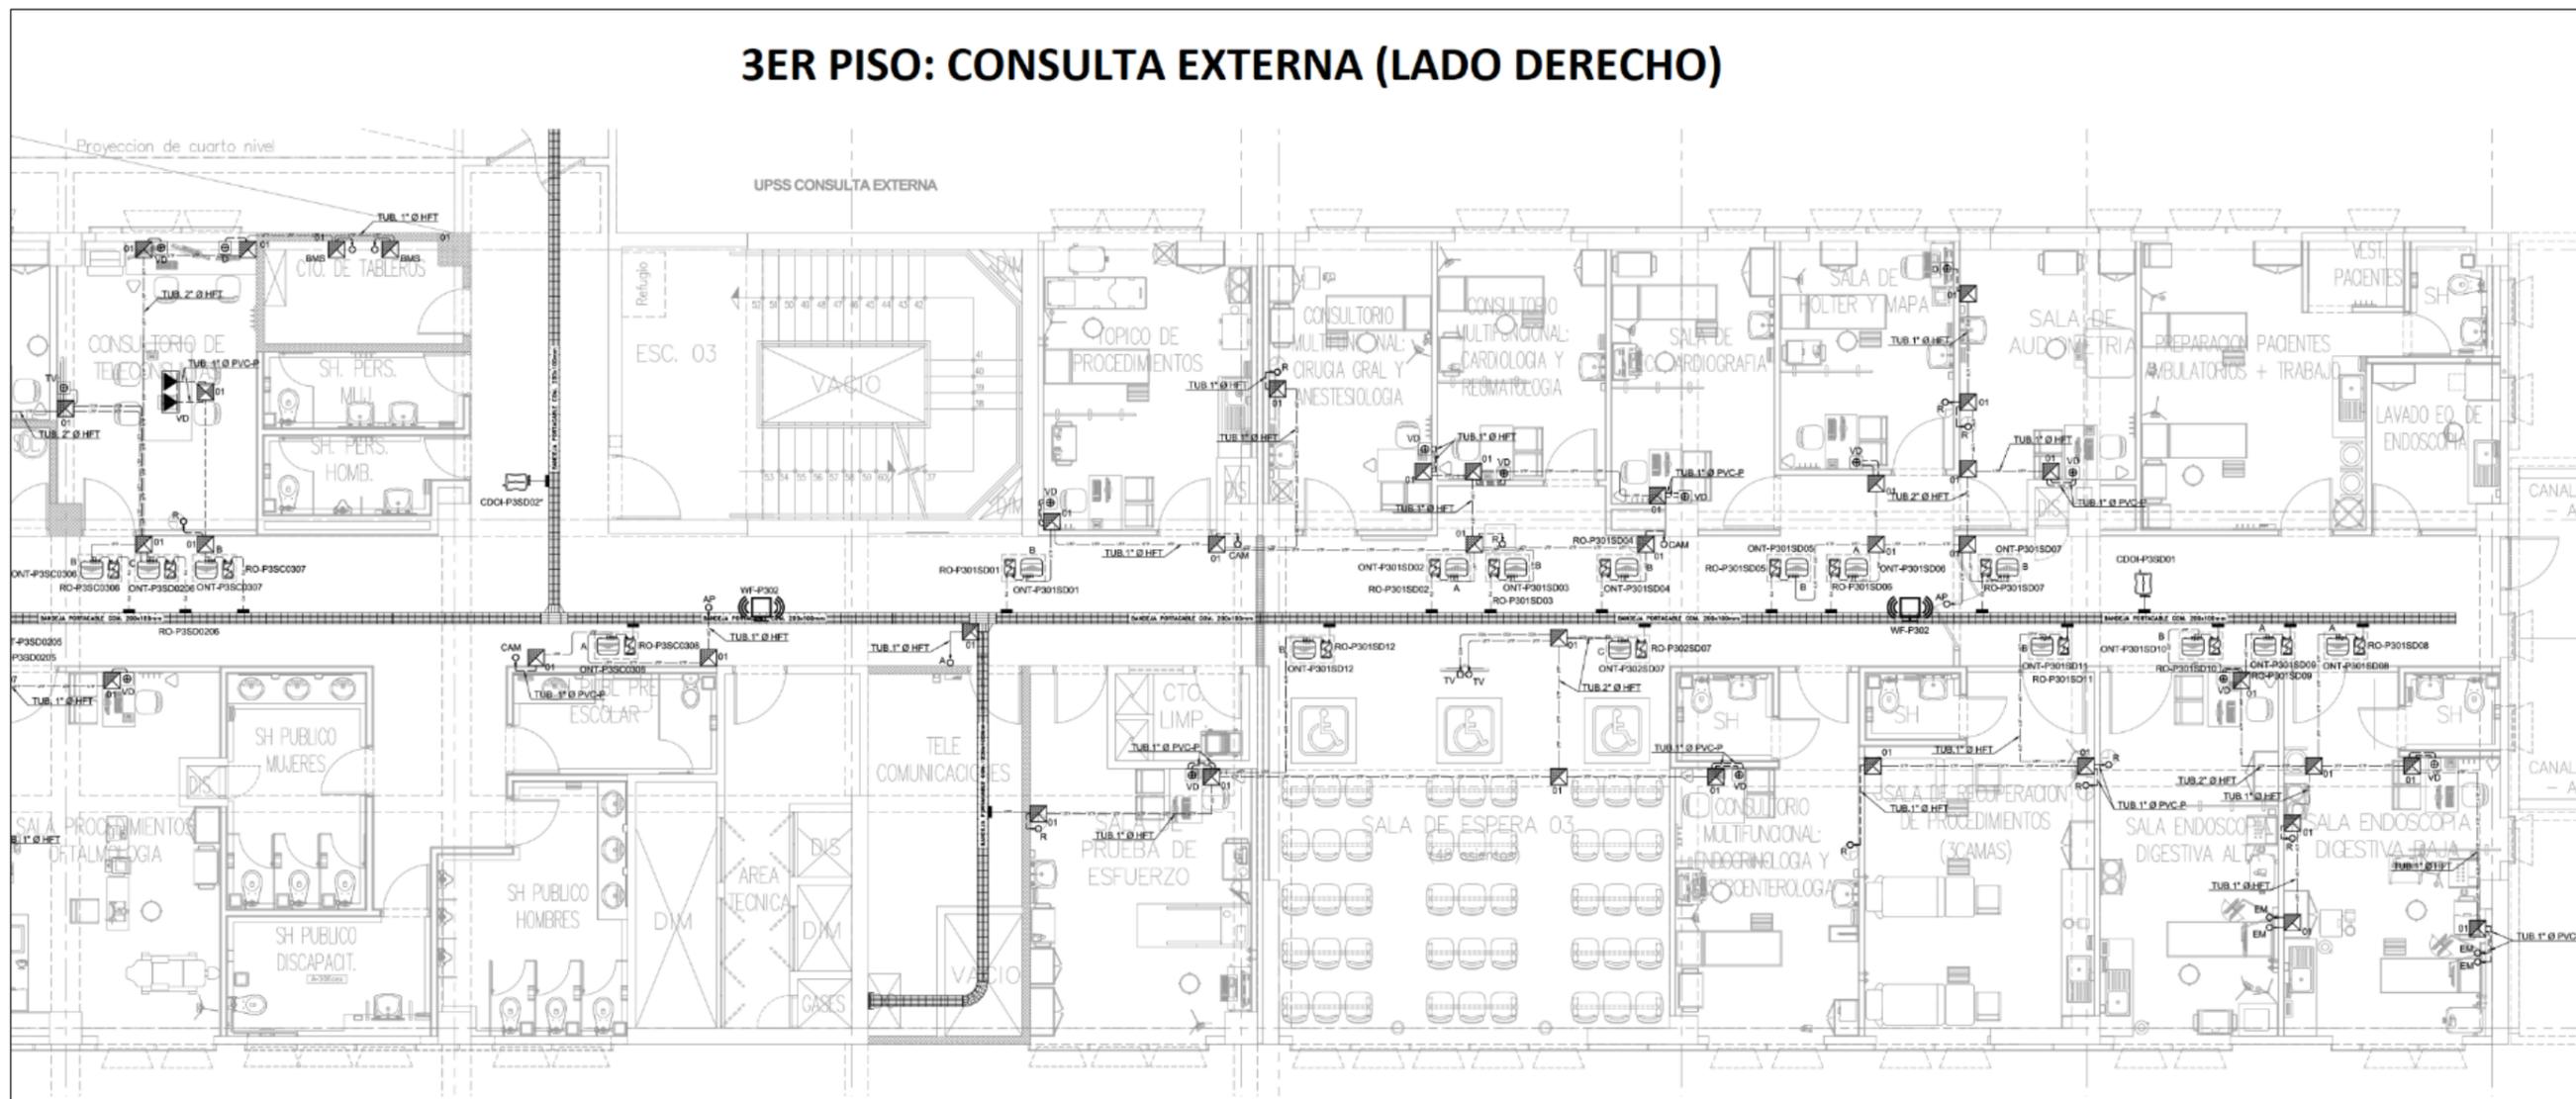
Plano técnico 3er piso: Consulta Externa (lado derecho).
